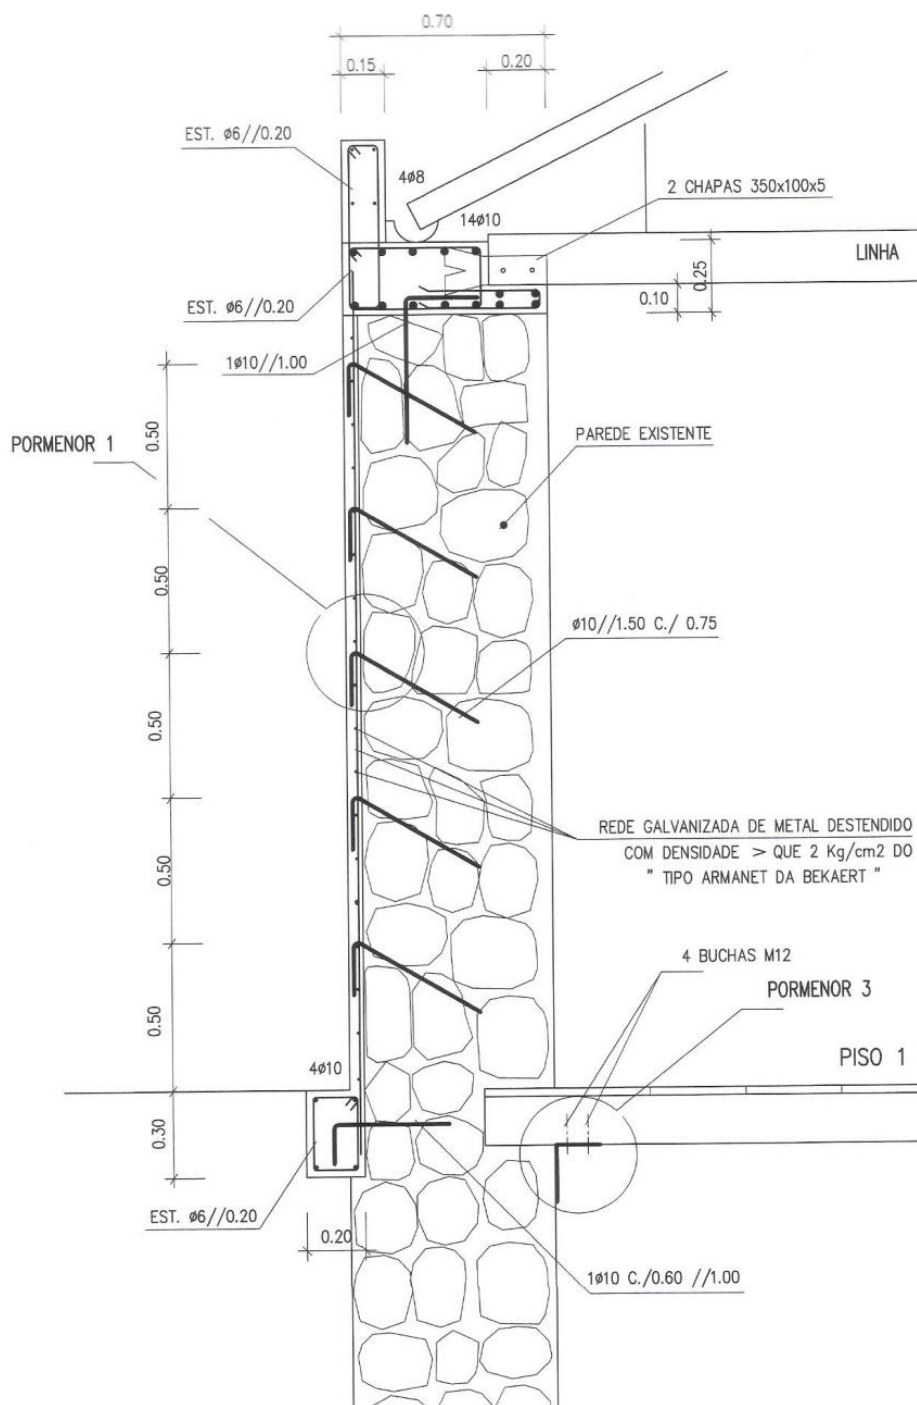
13 Reboco armado numa face e pormenores de ligação do pavimento à alvenaria de pedra e da cinta de remate de reboco á alvenaria, [37].
